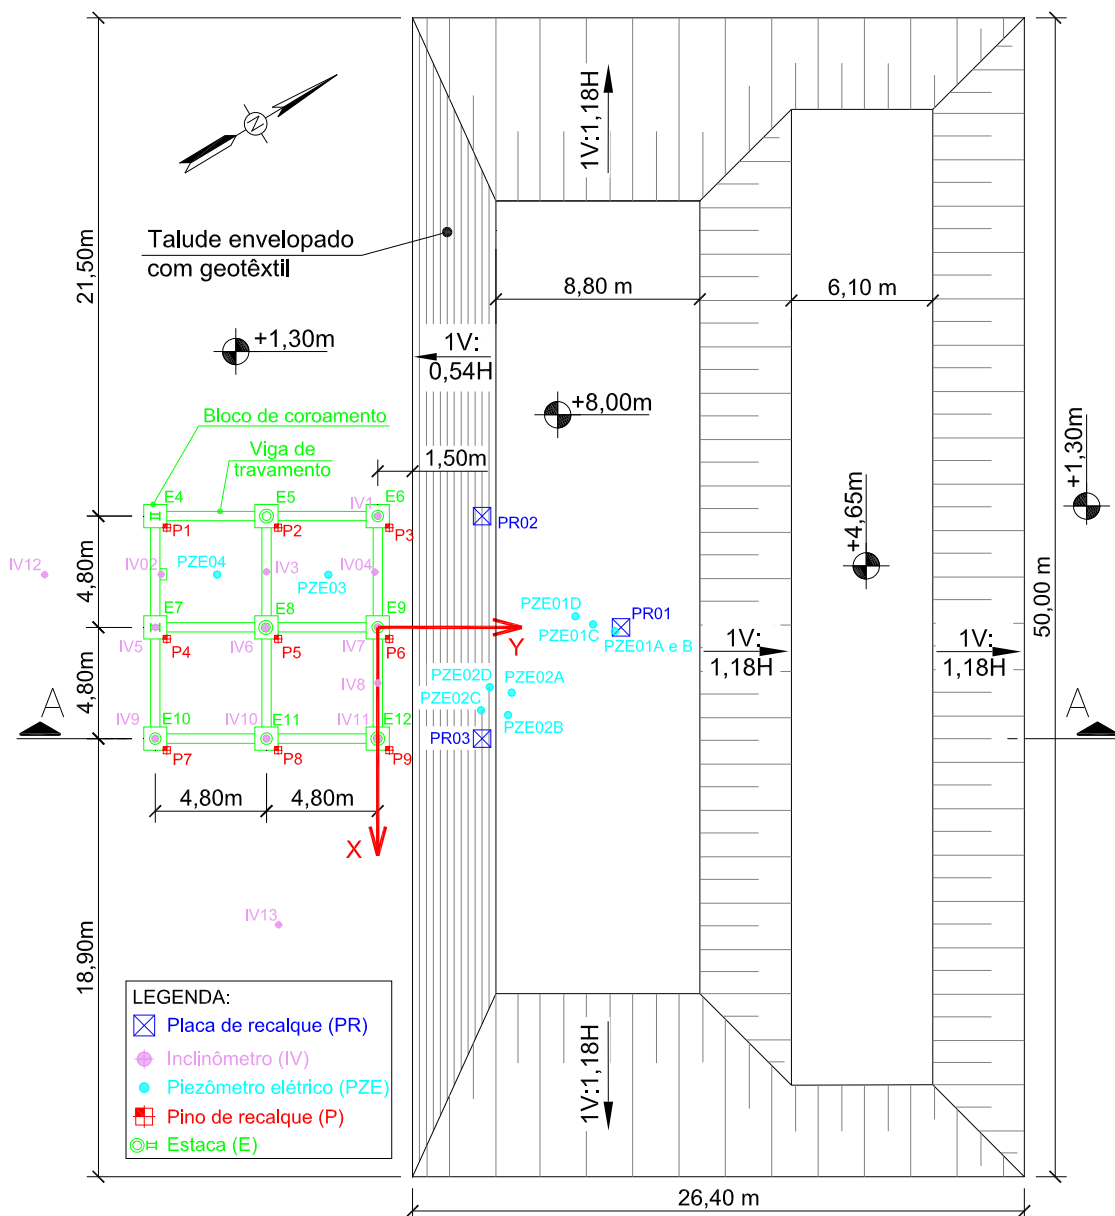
Planta de localização do aterro, do estaqueamento e da instrumentação
